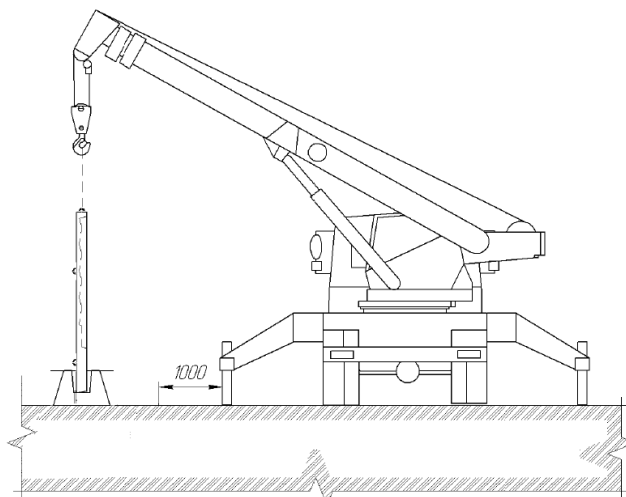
Демонтаж панелей сборных железобетонных оград
